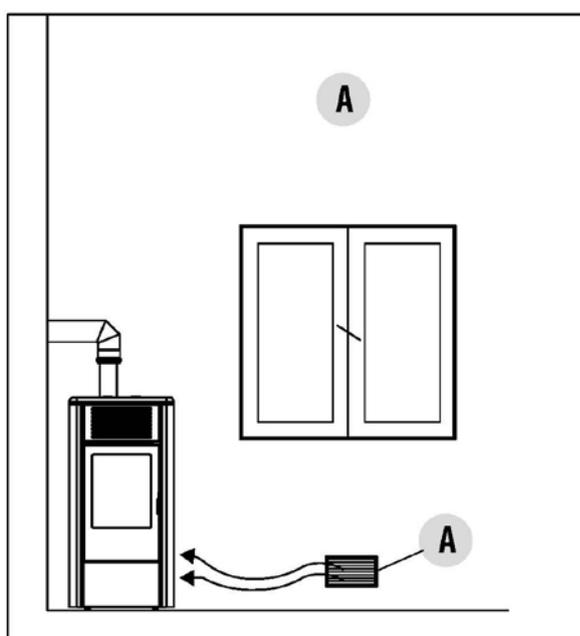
DIRETTAMENTE DALL'ESTERNO
